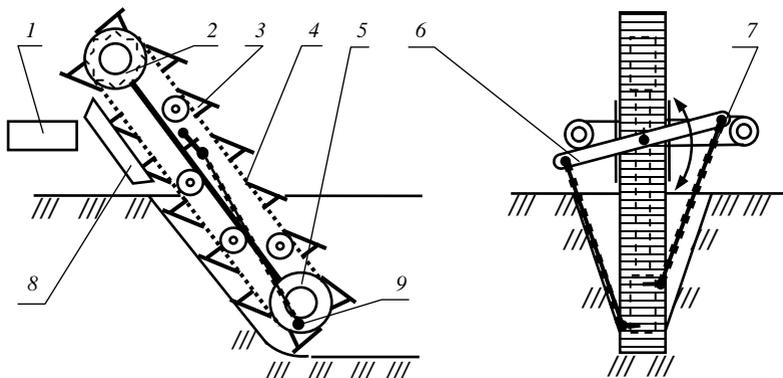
Схема скребкового цепного траншеекопателя с подъемным лотком и откосообразователями: 1 – поперечный ленточный конвейер; 2 – ведущая звездочка; 3 – скребки; 4 – рабочая цепь; 5 – натяжные колеса; 6 – балансир; 7 – цепь; 8 – подъемный лоток; 9 – ось
